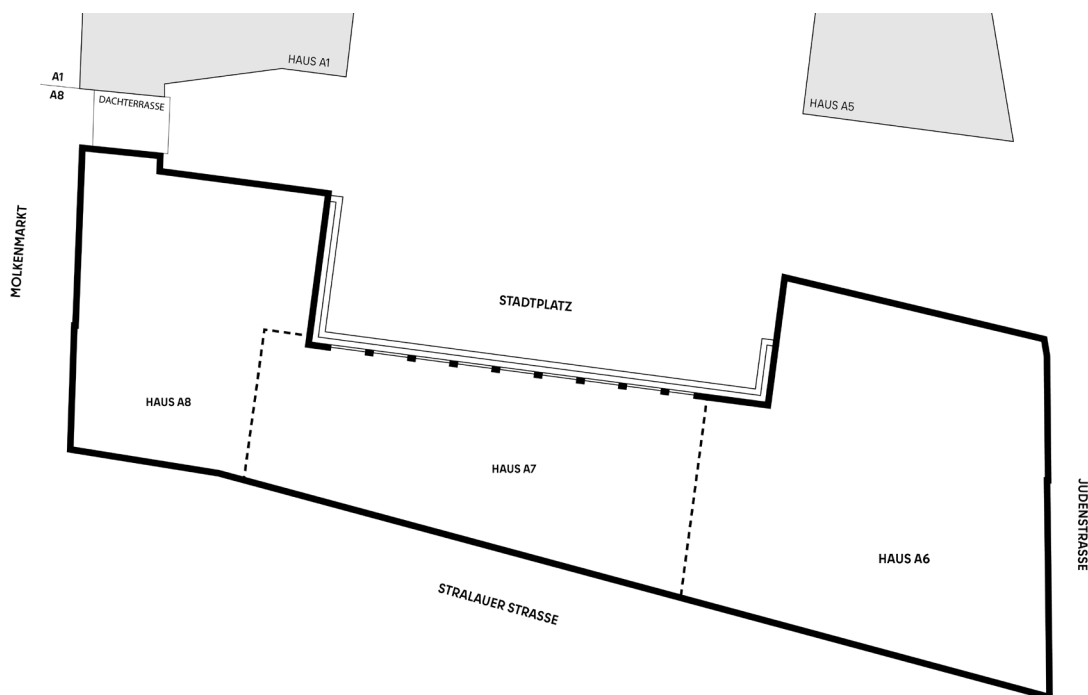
Schematischer Grundriss Regelgeschoss
